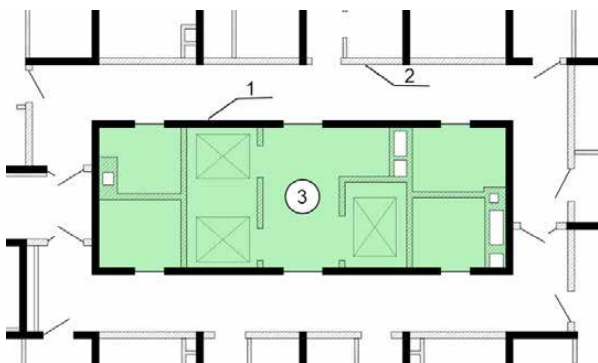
Фрагмент плану монолітно-каркасного будинку: 1 – залізобетонні елементи каркаса; 2 – легкобетонні елементи каркаса; 3 – укриття [3]
